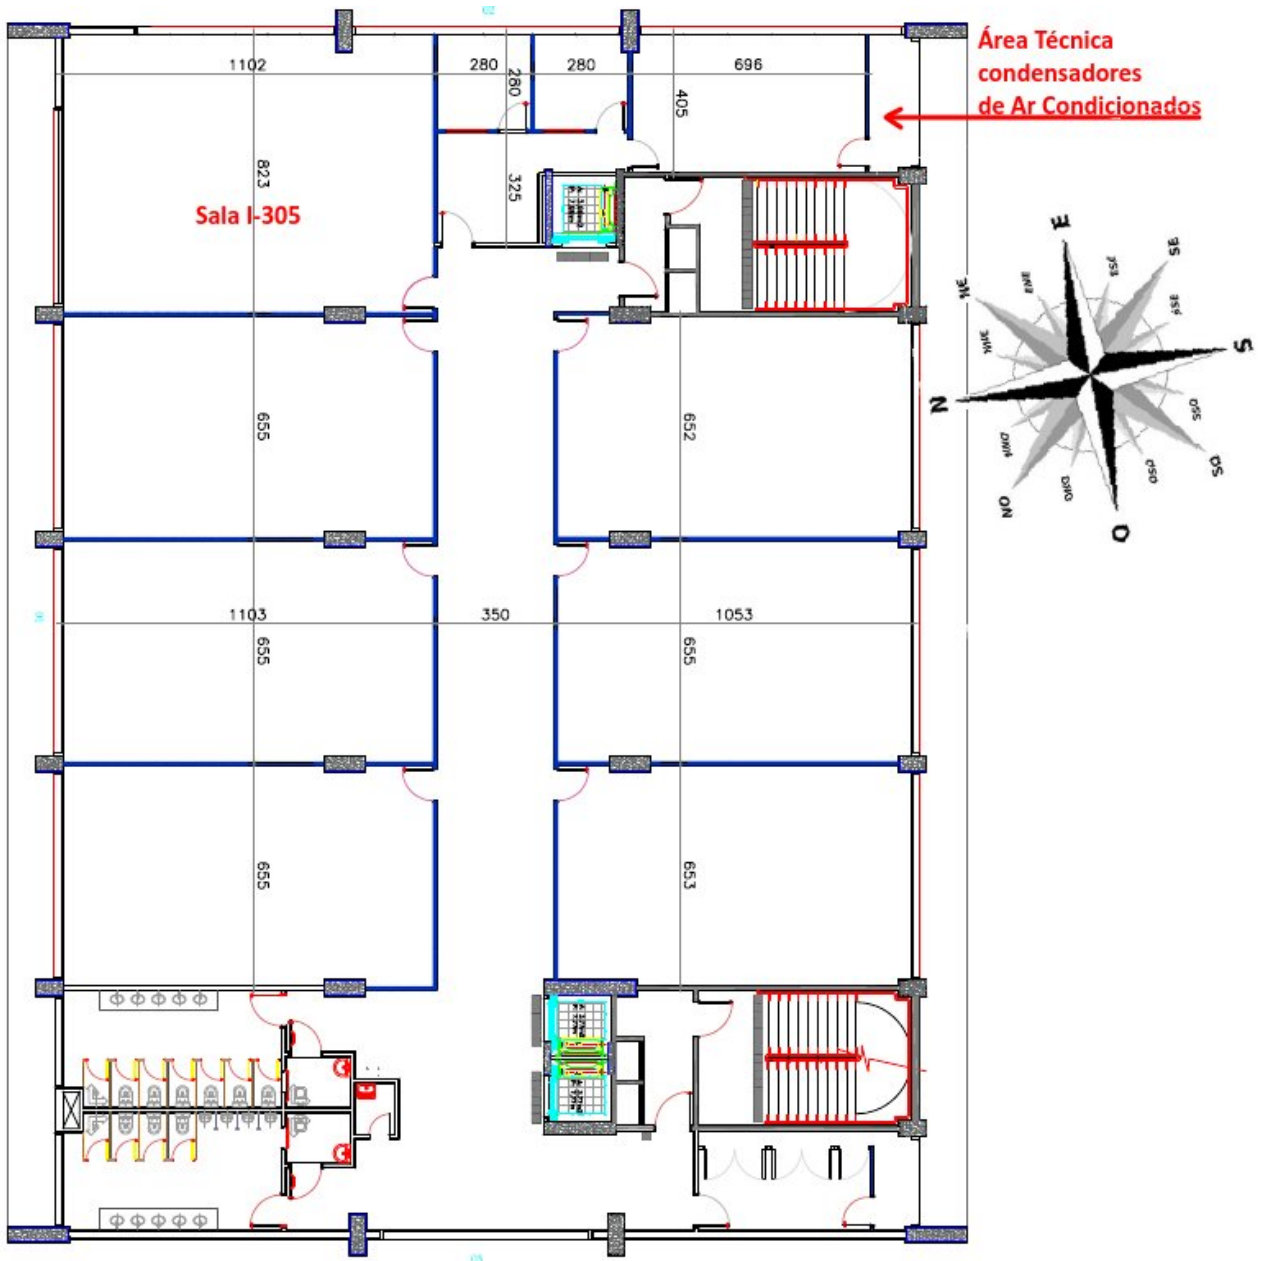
Planta baixa do terceiro andar do prédio. Apontamento do Norte aproximado.
